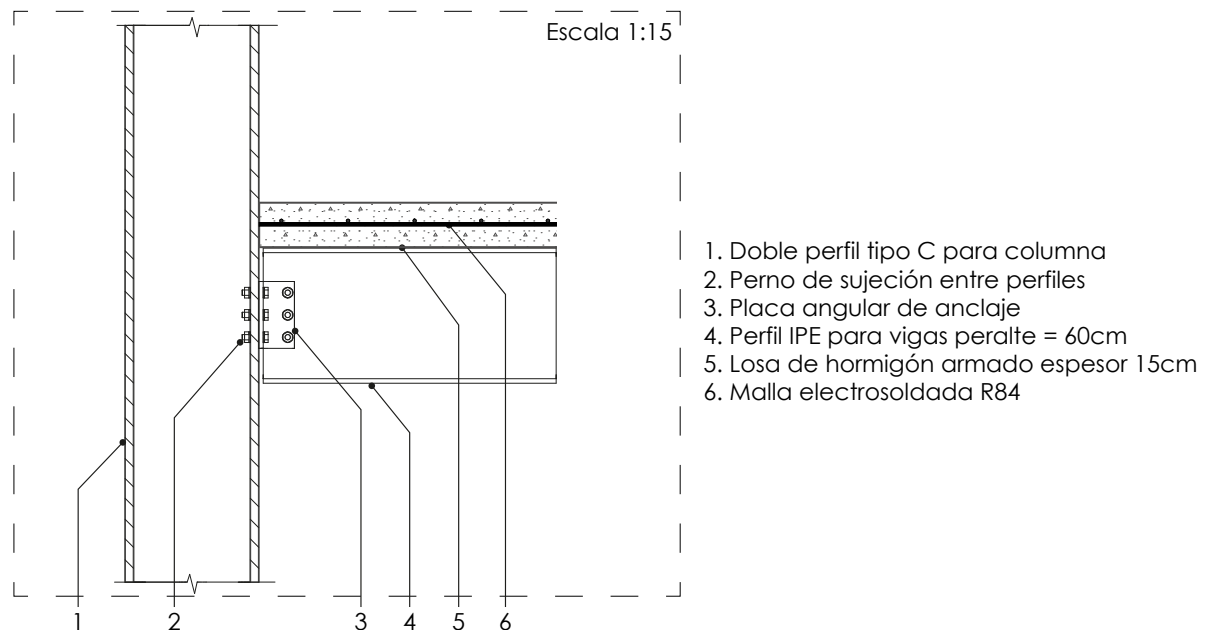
Detalle constructivo unión entre columna y viga metálica
